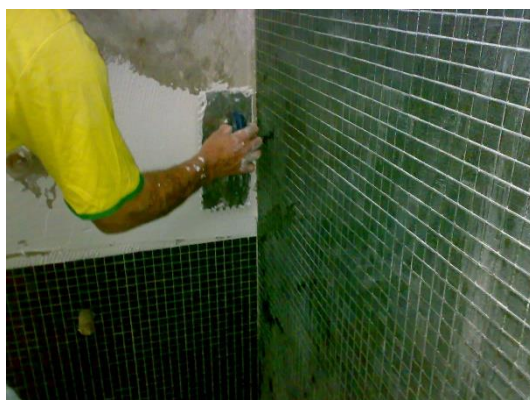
Execução de revestimento nas instalações sanitárias em pastilha
